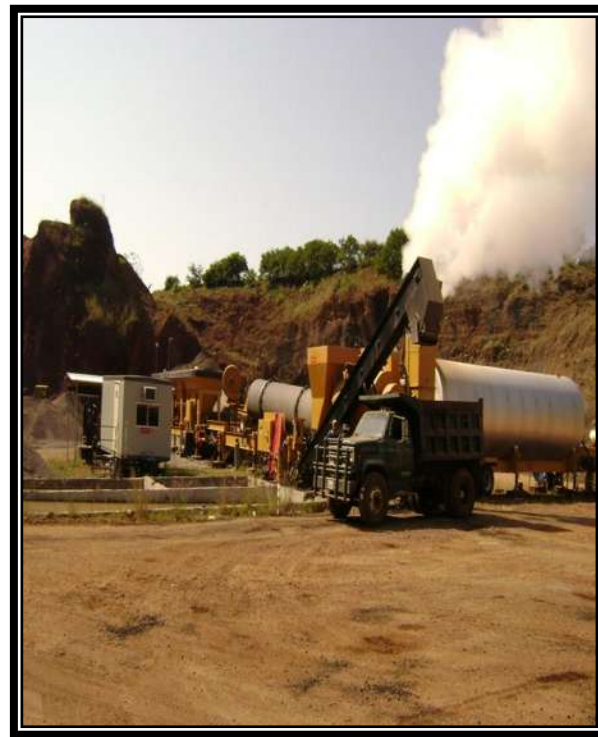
PRODUCCION DE CONCRETO ASFALTICO EN LA PLANTA.
